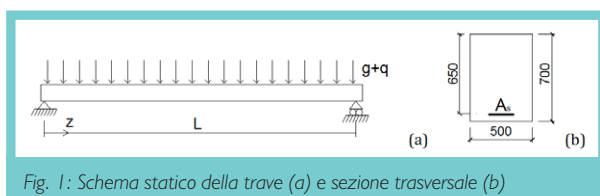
Schema statico della trave (a) e sezione trasversale (b)
